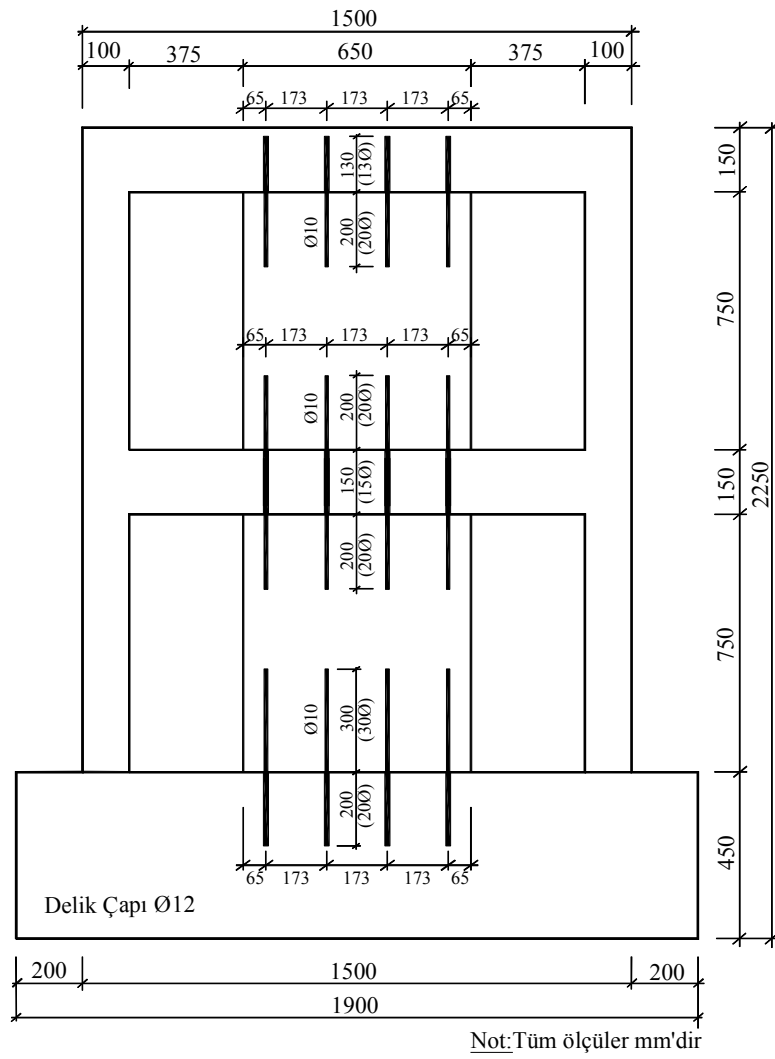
Deney Elemanı-8'in donatı detayı
